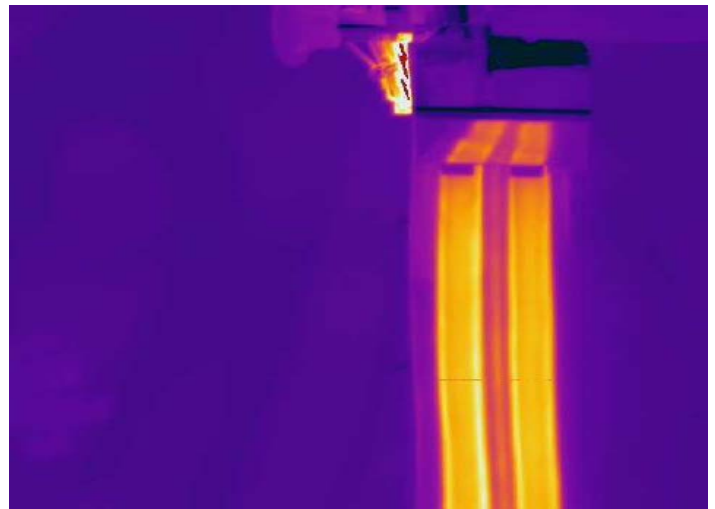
Vue Infrarouge de la machine en cours de soudage d'une nappe de PEHD.
